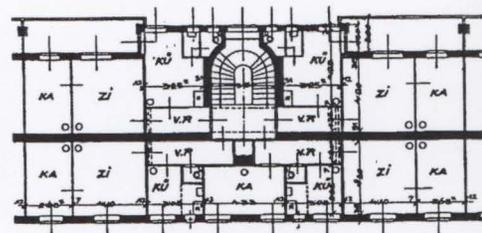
Grundriss Karl- Marx-Hof 1927
